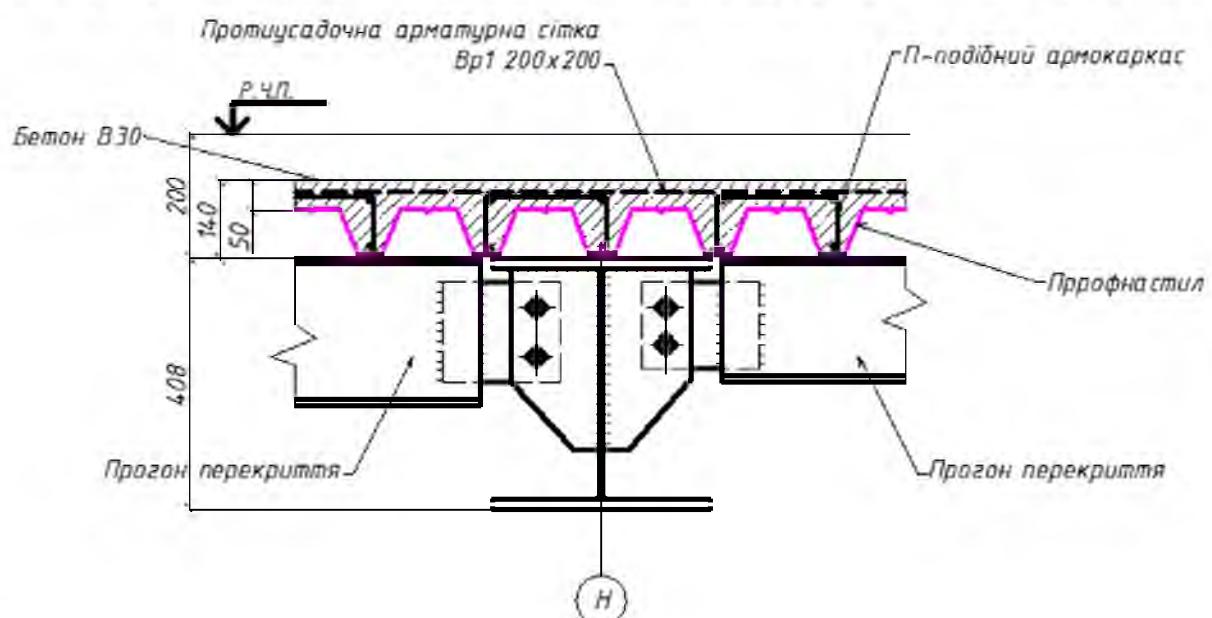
Фрагмент монолітної залізобетонної плити перекриття по профільованому металевому настилу
